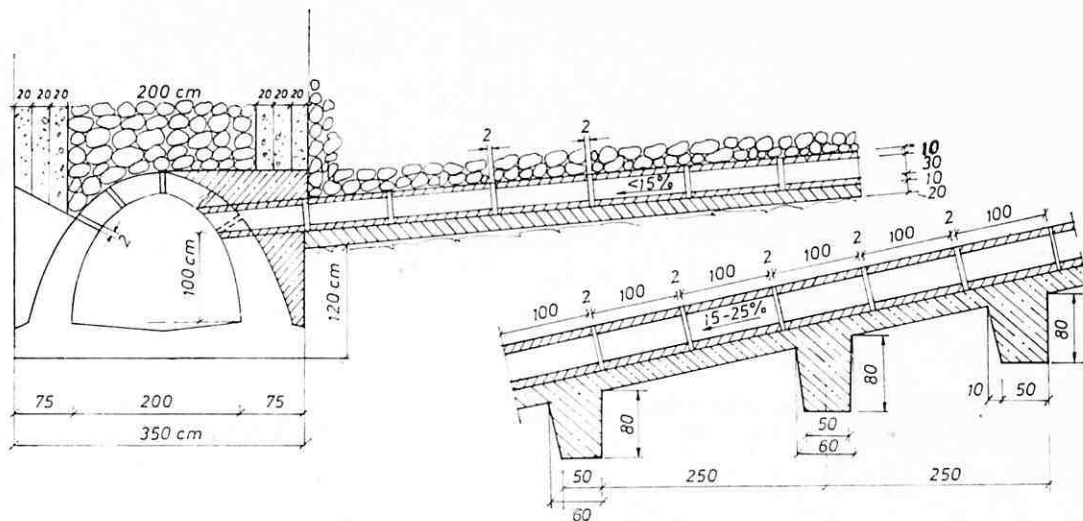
Poprečni presek bočnih drenova i rebara.
